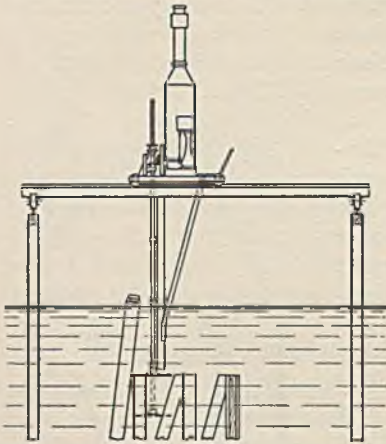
Grundsäge auf einem Wagen über ein festes Gerüst laufend.
